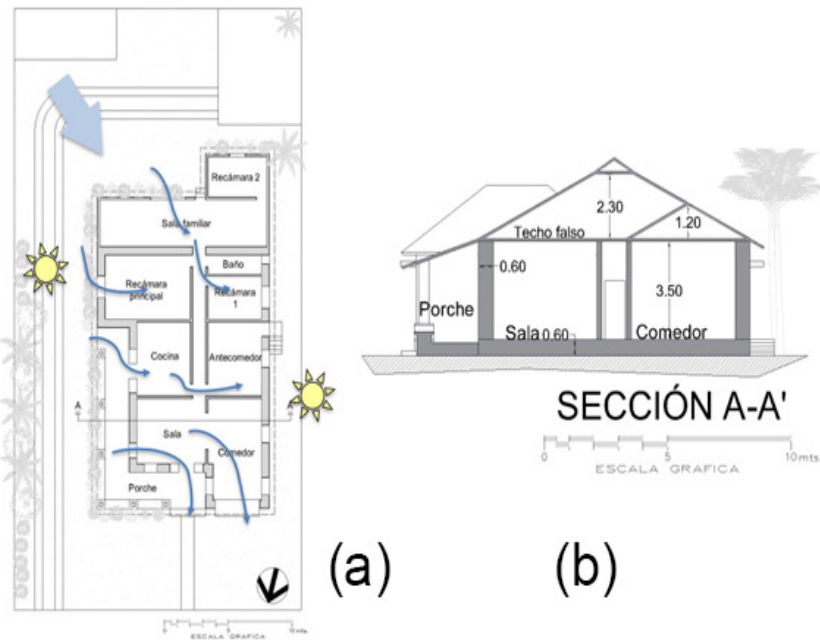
(a) Plantas arquitectónicas (b) Corte. Fuente. Elaboración de los autores.
